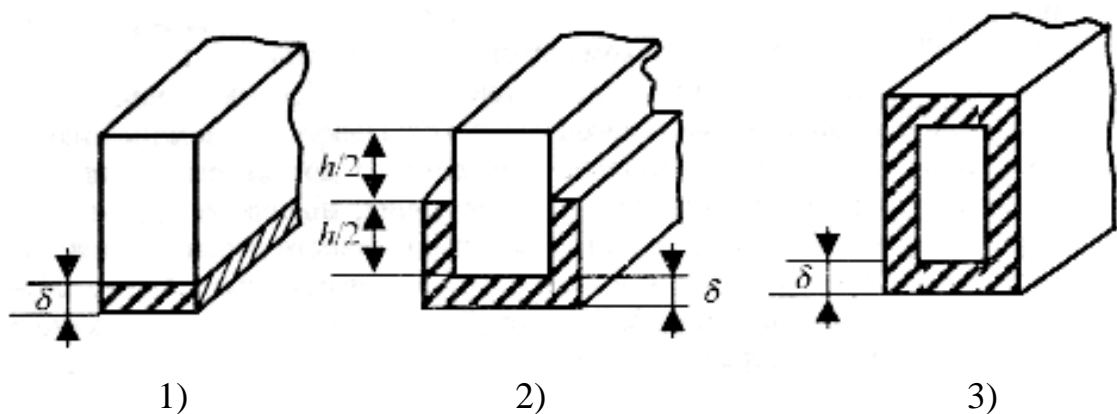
Схема підсилення залізобетонних балок: 1 – нижня розтягнута грань балки; 2 – розтягнута зона до осьової лінії; 3 – у вигляді обійми.
